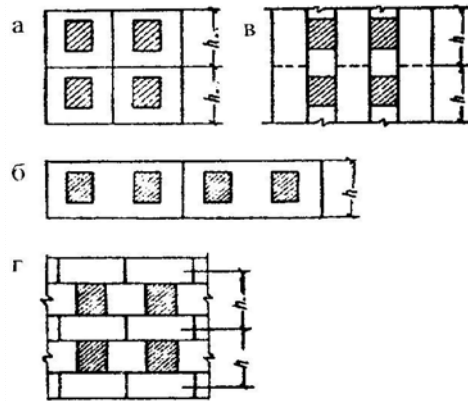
Схеми розрізки зовнішніх стін на панелі:
